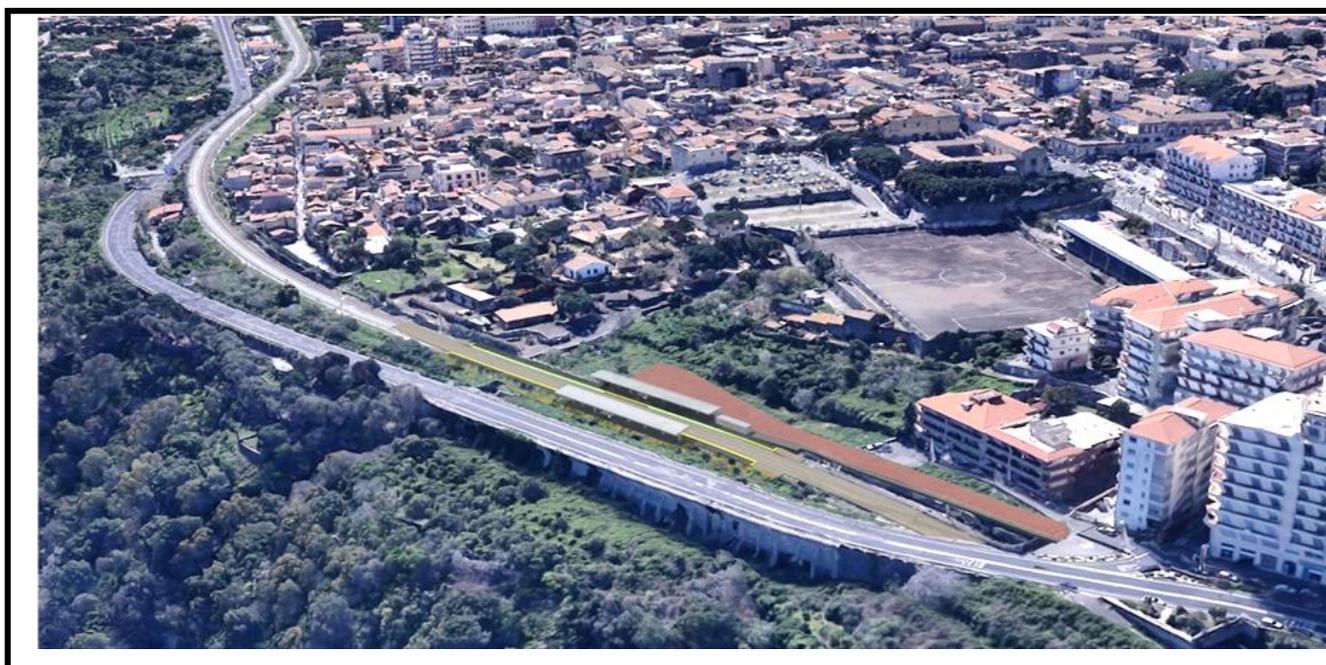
Foto inserimento progetto Fermata Acireale - Bellavista
